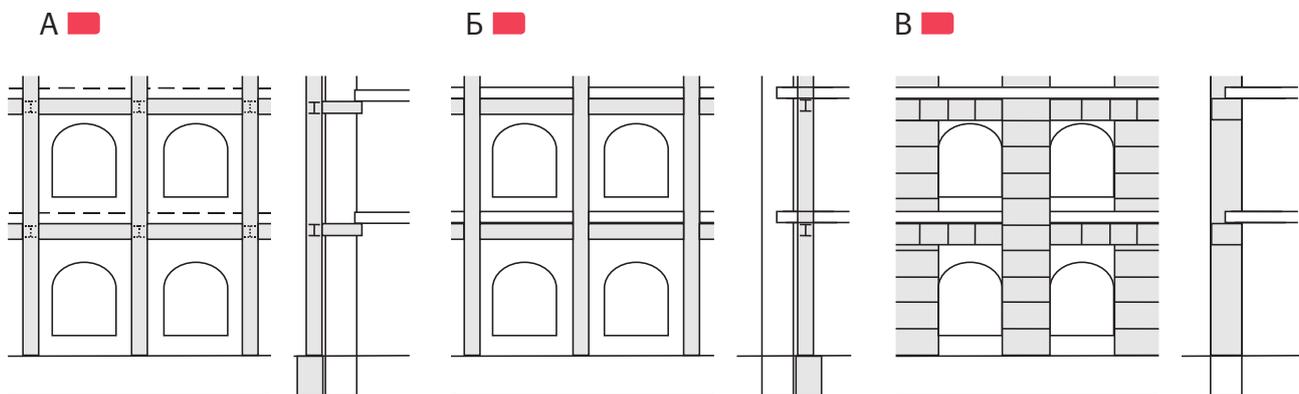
Схема замены каменной фасадной стены с независимыми стоечно-ригельными каркасами: А – снаружи; Б – изнутри; В – сталекирпичными ригелями и колоннами с пересадкой перекрытий; закрашенные области – новый каркас
